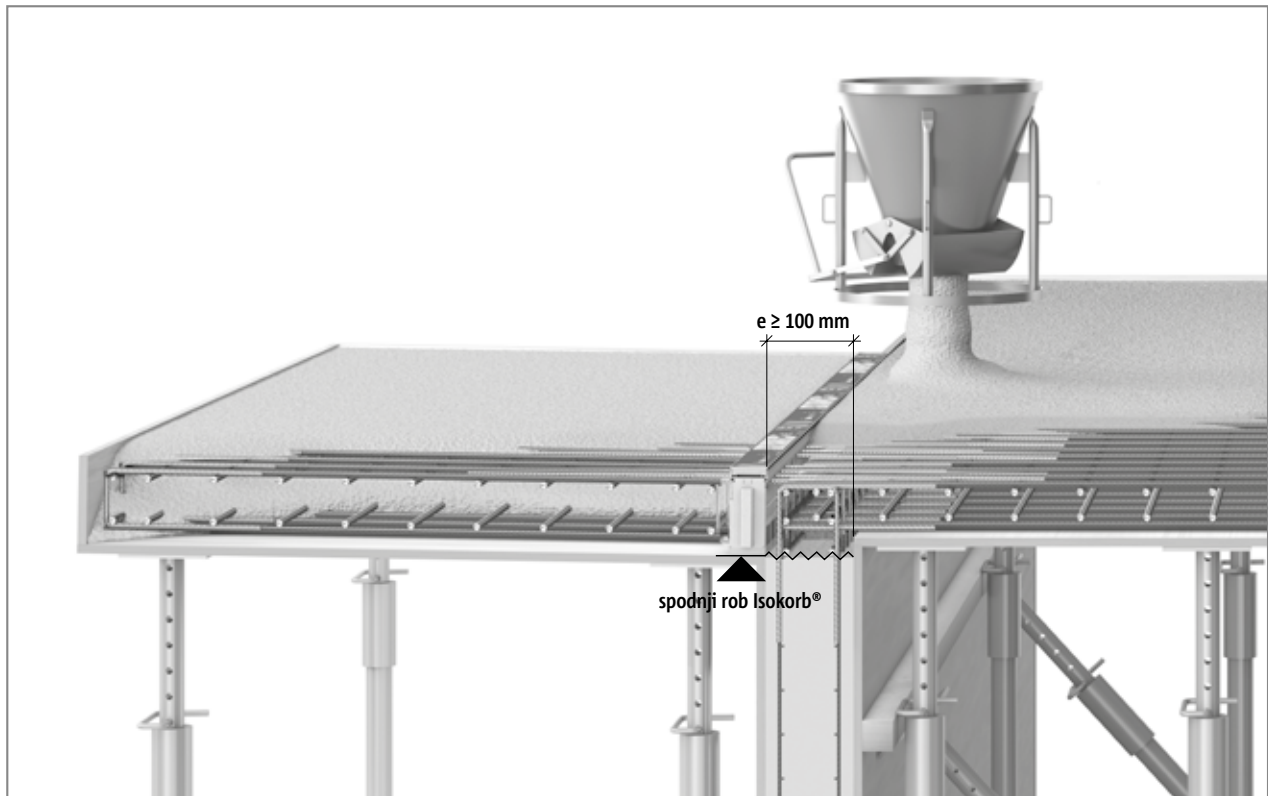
Schöck Isokorb® T tip KL: priprava armature za betoniranje in nameščanje T tip KL
